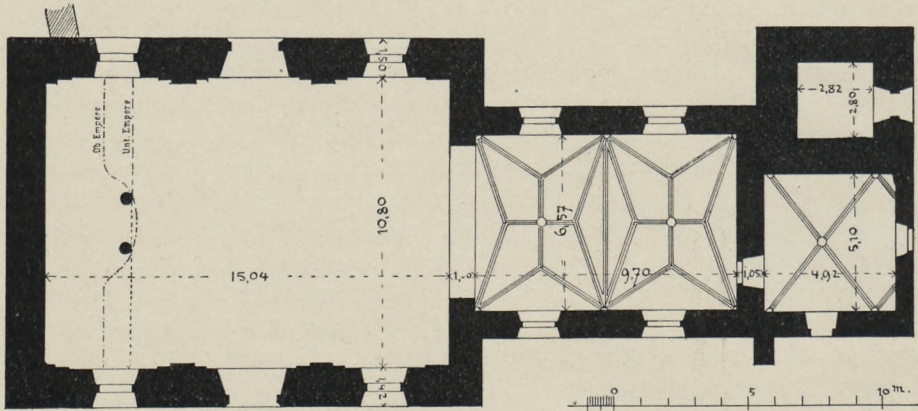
Altendorf. Pfarrkirche. Grundriß.
